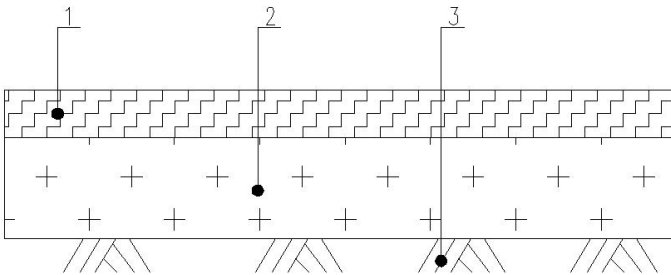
全透式透水水泥混凝土人行道路、非机动车道面结构示意图
